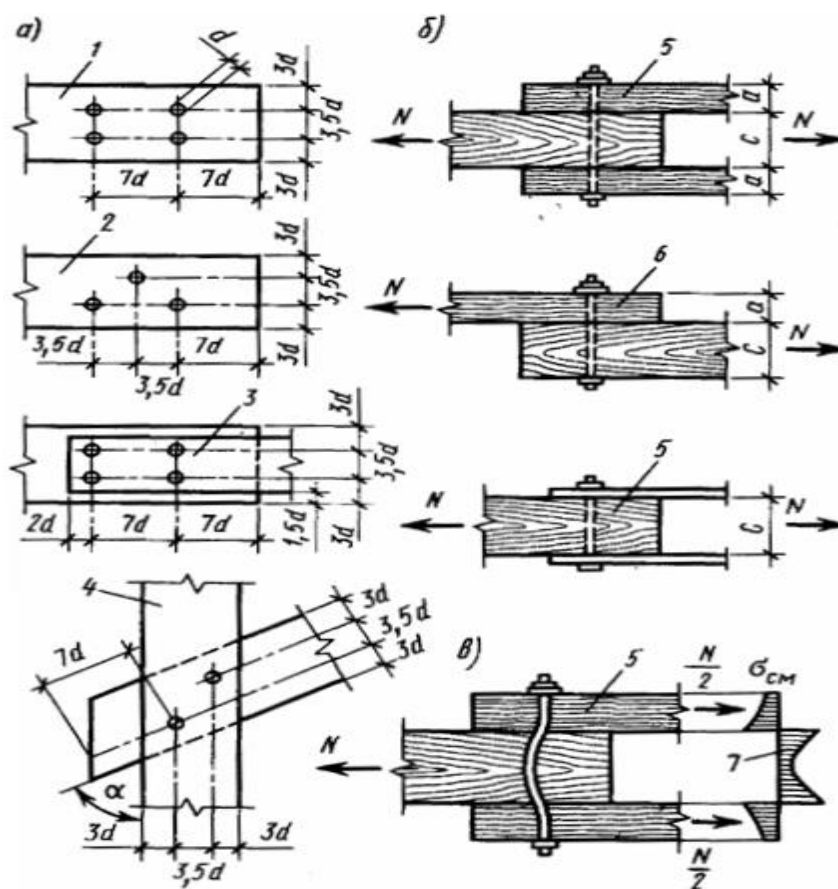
З'єднання на болтах, що згинаються: а — схеми розміщення; б — розрахункові схеми; в — схема роботи; 1 — пряме розміщення; 2 — шахове; 3 — при металевих накладках; 4 — в з'єднаннях під кутом; 5-симетричне; 6 — несиметричне; 7 — епюра напруг зминання деревини
